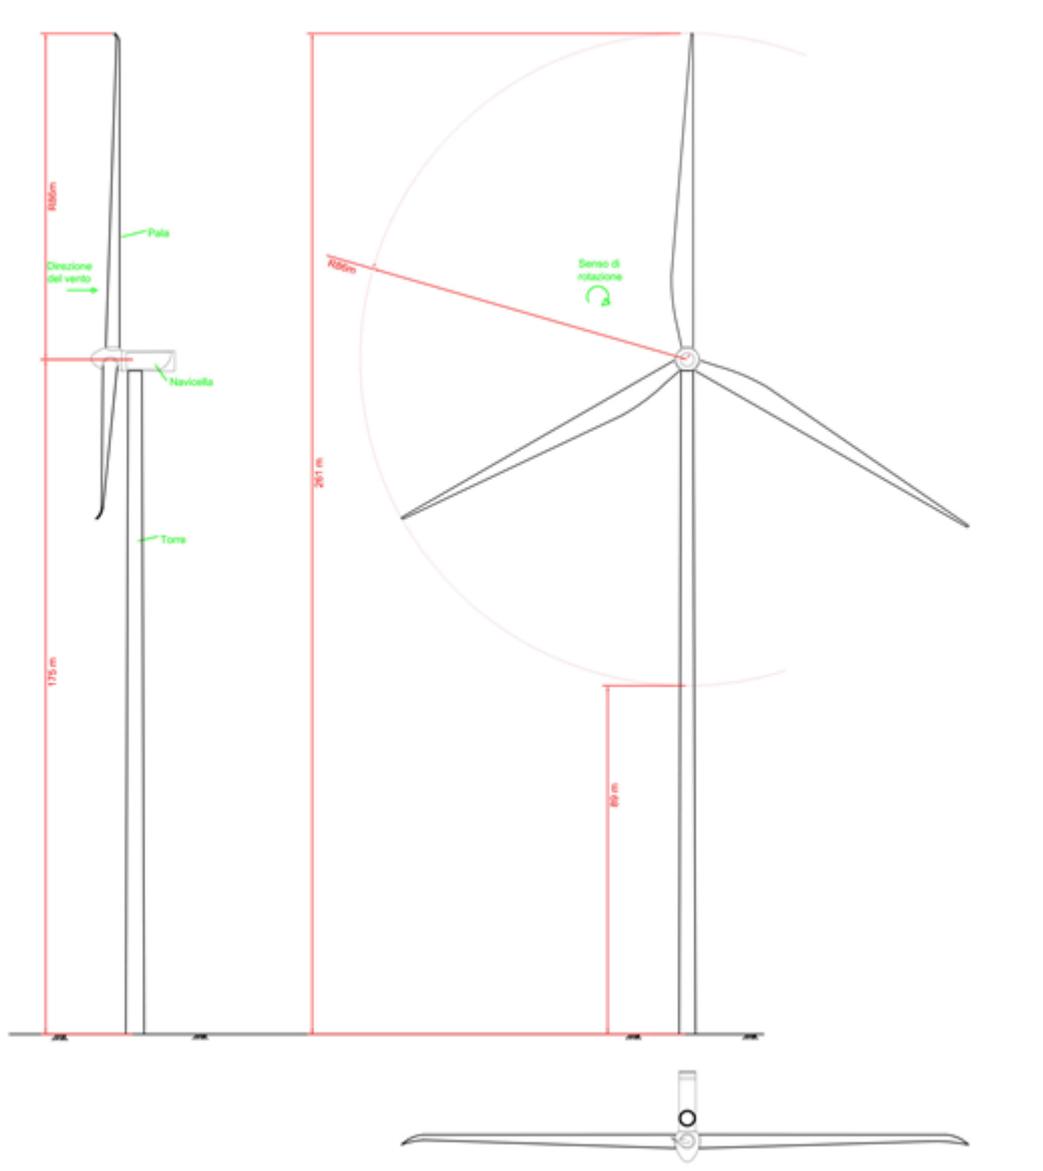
Aerogeneratore tipo: prospetto laterale,prospetto frontale e pianta
